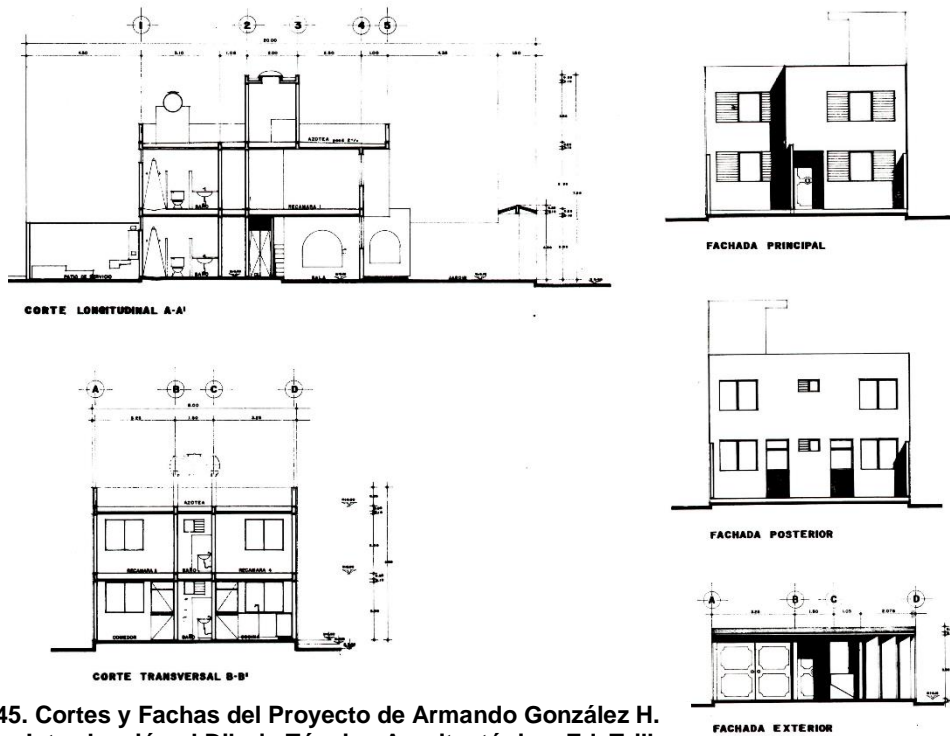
Cortes y Fachas del Proyecto de Armando González H.
